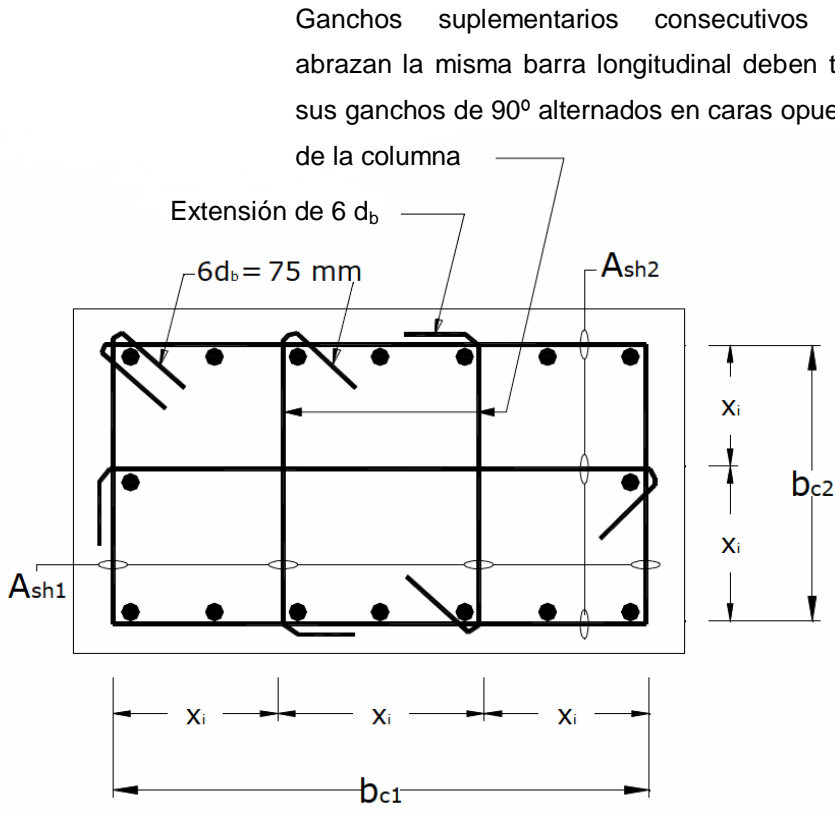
Ejemplo de refuerzo transversal en columnas
